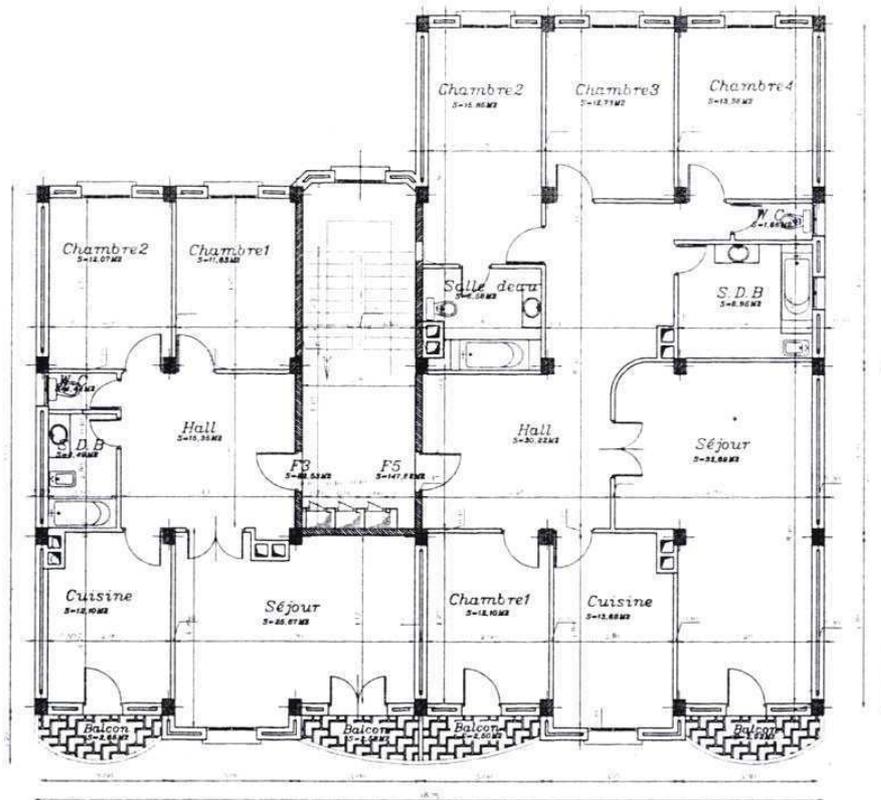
Plan du 4^{ème} étage d'un autre immeuble promotionnel
